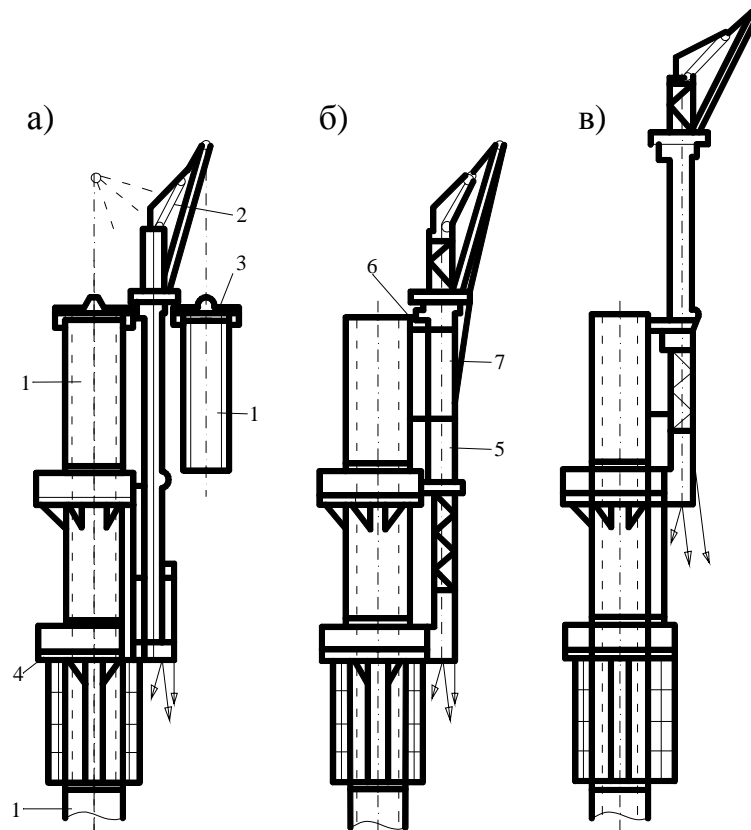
Схема монтажу щогли методом нарощування:
